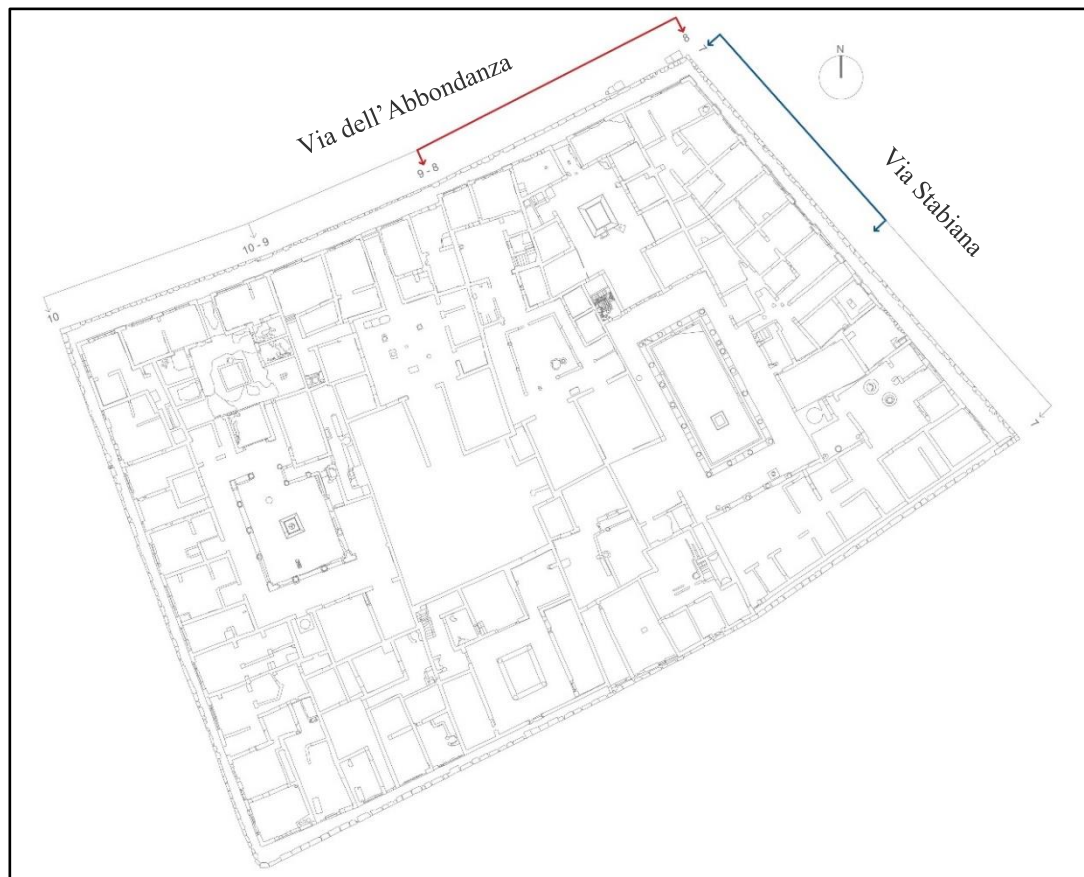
Planimetria dell'insula 4 della Regio VIII con indicazione delle sezioni descritte nel testo
